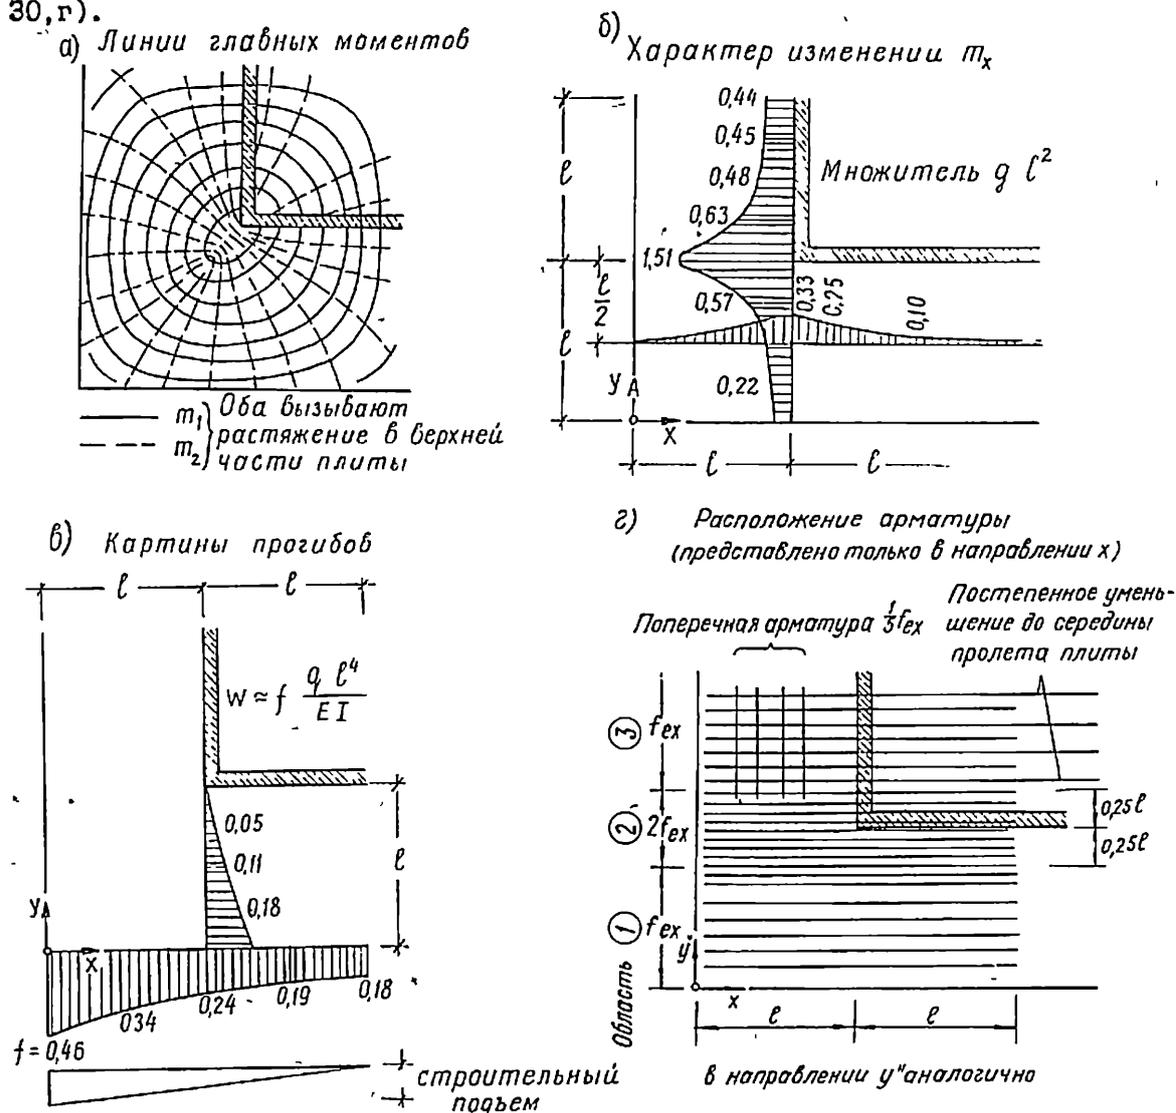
30. Линии главных моментов и арматура плиты, выступающей над углом стены
